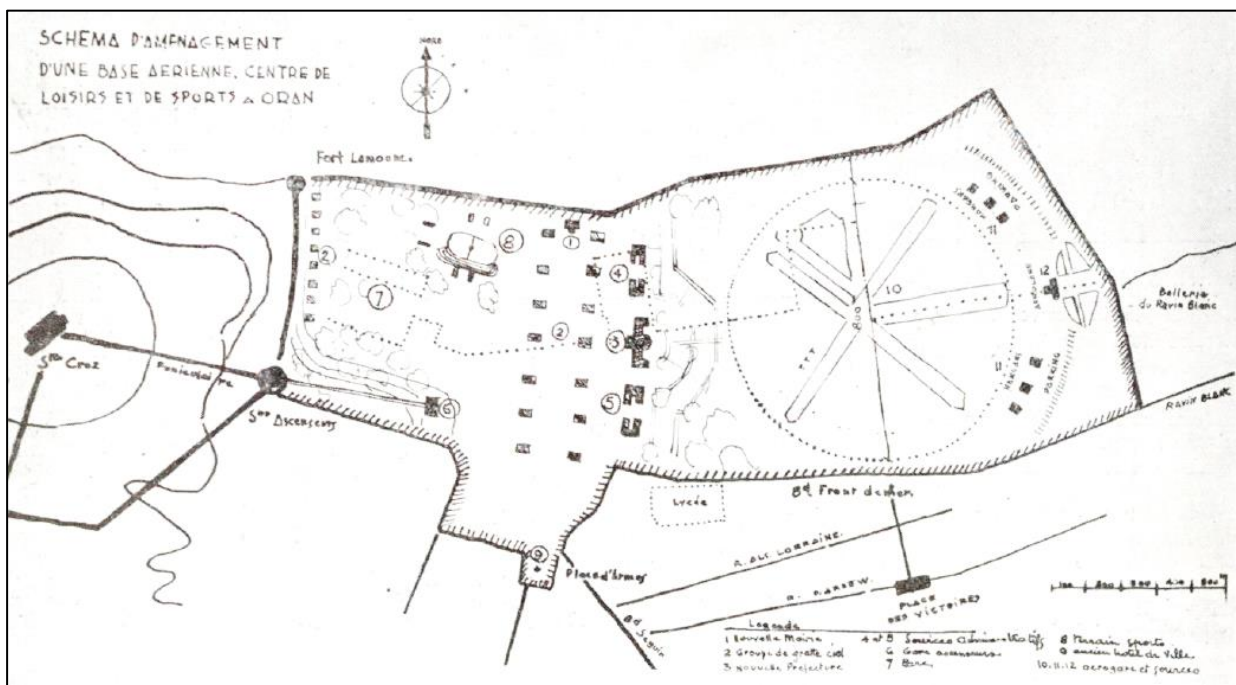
Schéma du plan du nouveau projet centre urbain à Oran publié sur la revue chantiers 1937. (Source : Les Chantiers nord-africains, 1937)
